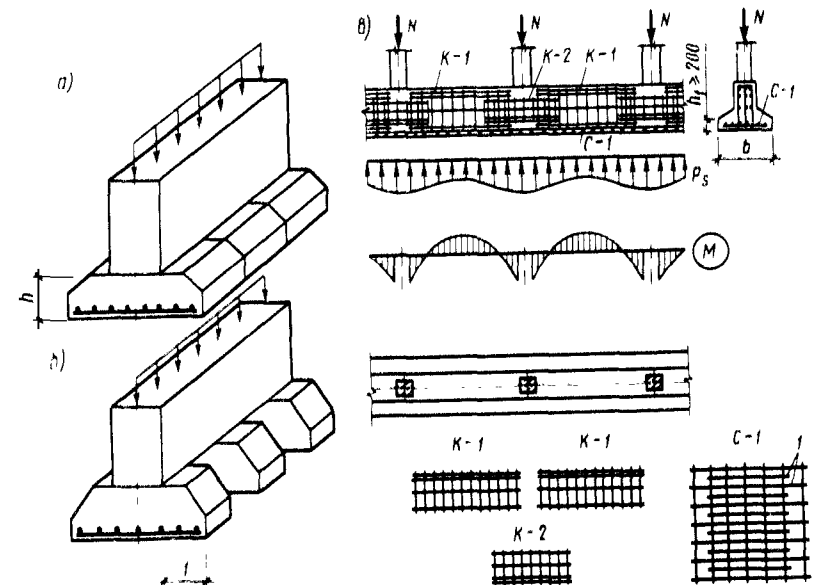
Ленточные фундаменты: а — фундамент под стены без зазоров; б — то же, с зазорами; в — фундамент под ряды колонн
